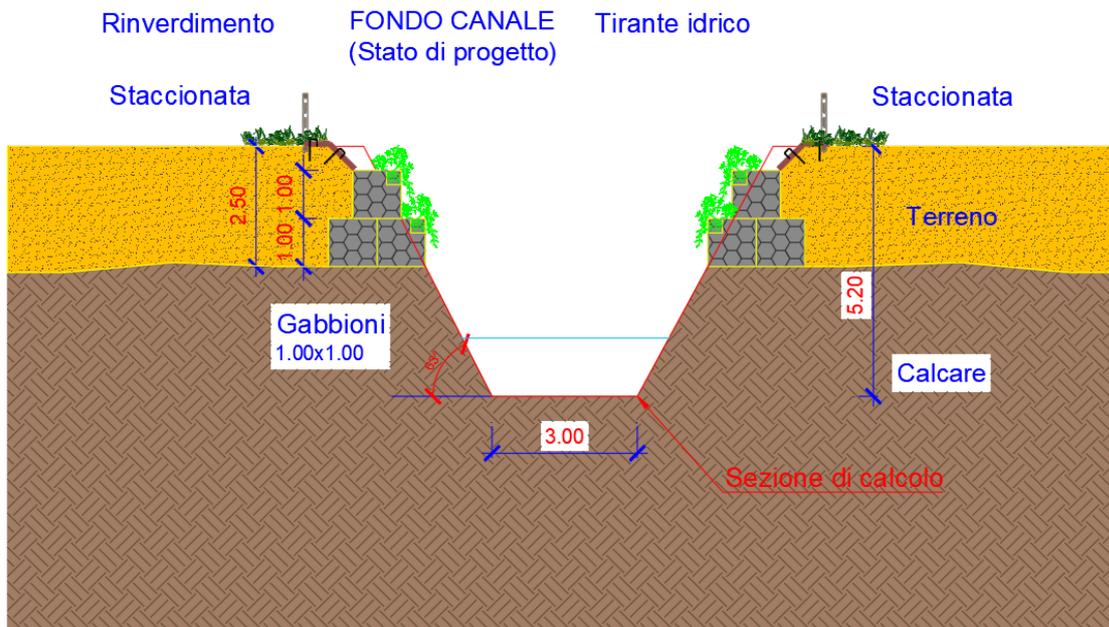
Sezione tipo del canale a sezione idraulica trapezia
